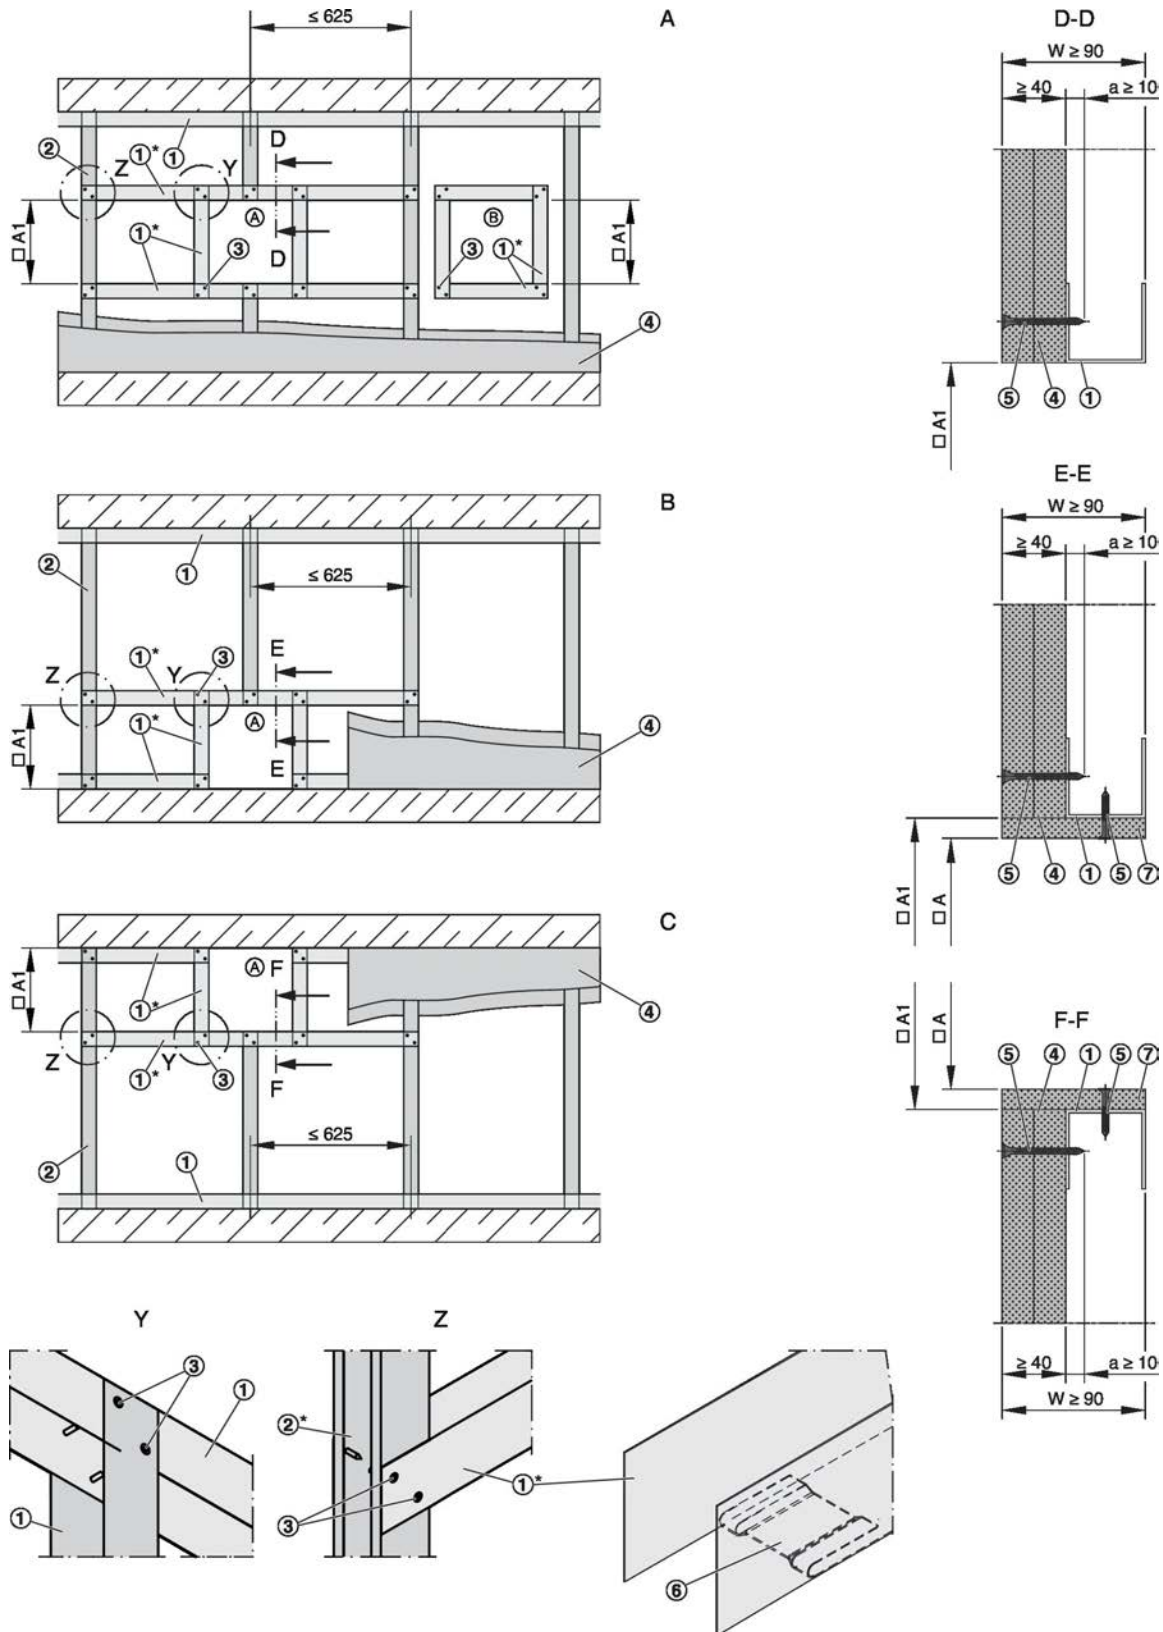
Patinillos con estructura de pared metálica y aislamiento a un lado
